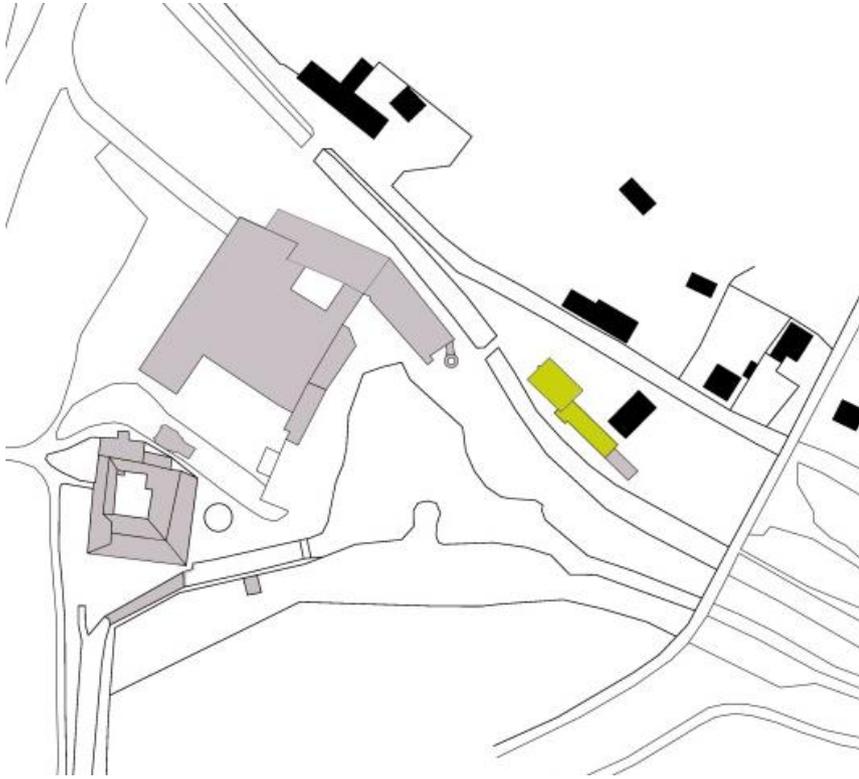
Lageplan mit Schlosserei und Zimmerei
